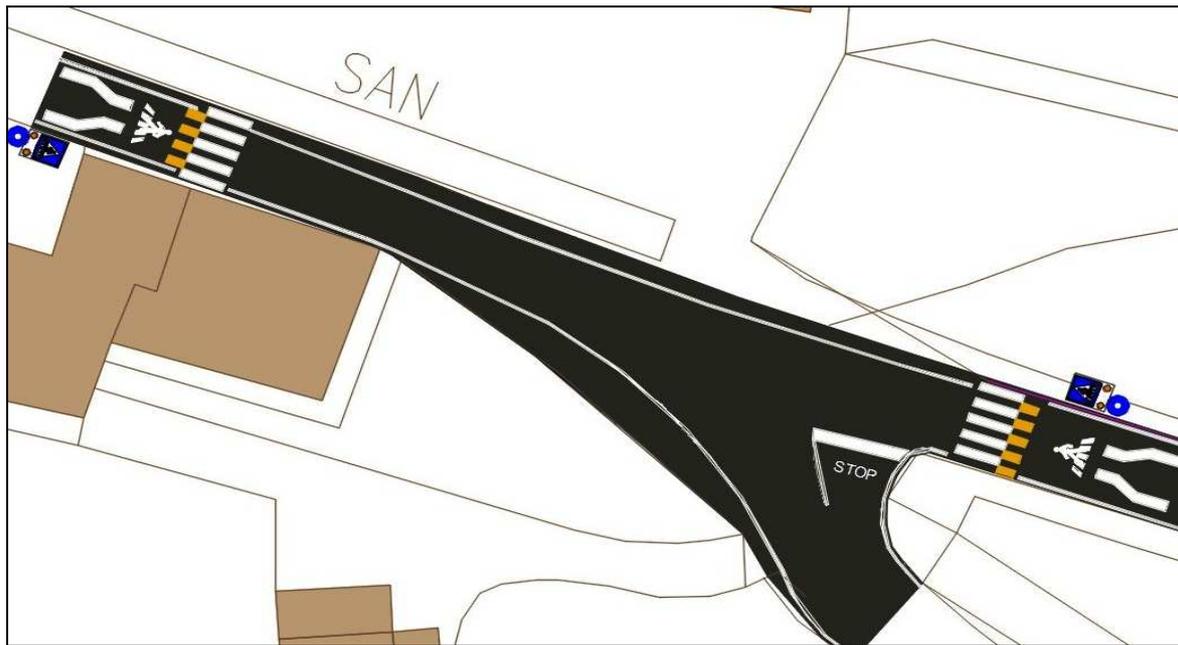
Stato di Progetto Via San Felice e Piteccio – Planimetria
